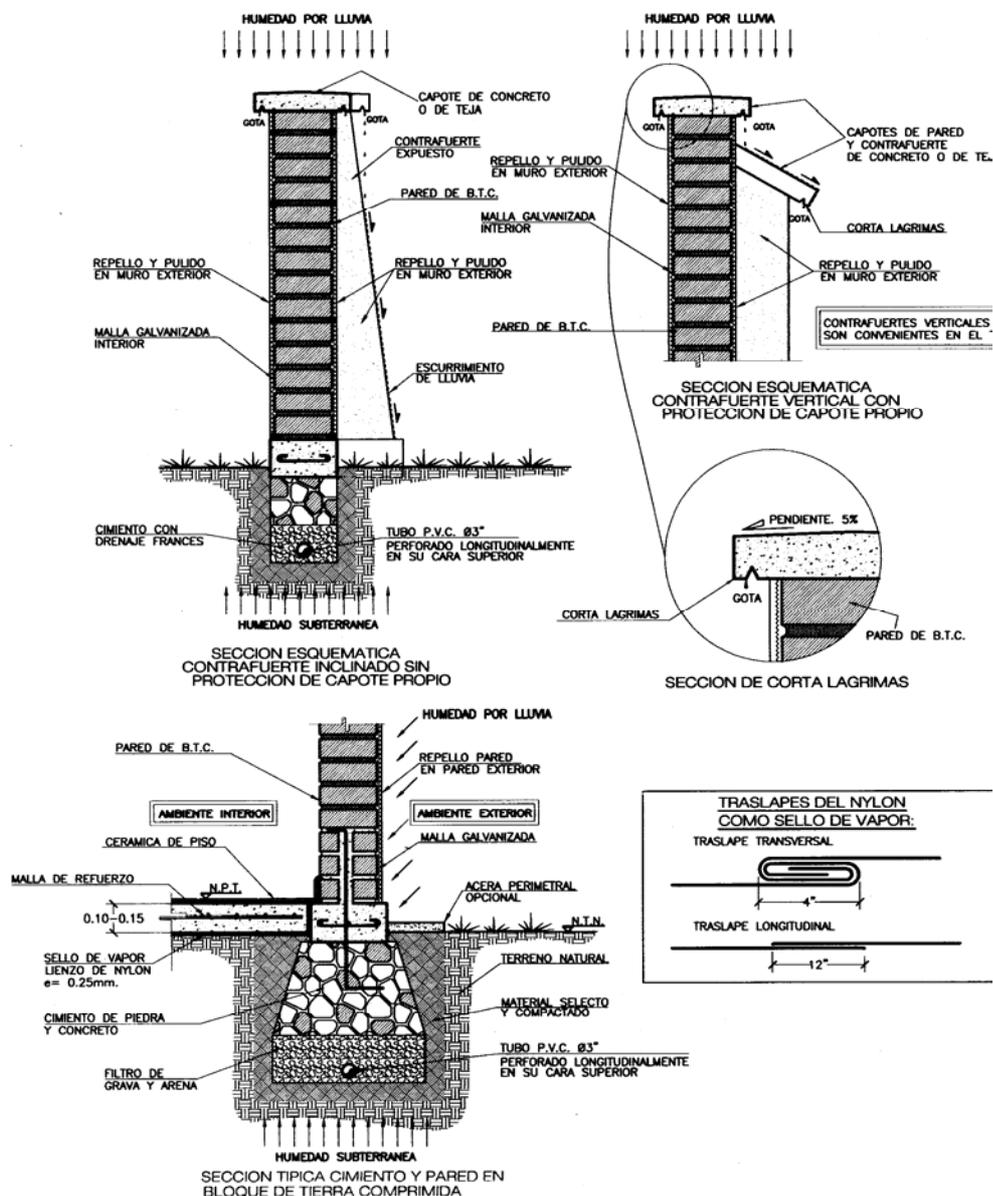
Detalles constructivos para humedad directa y por capilaridad
